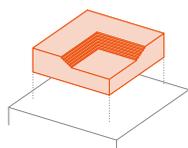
Lageplan Vertiefungsbereich Gewerbe (Eigene Darstellung)
